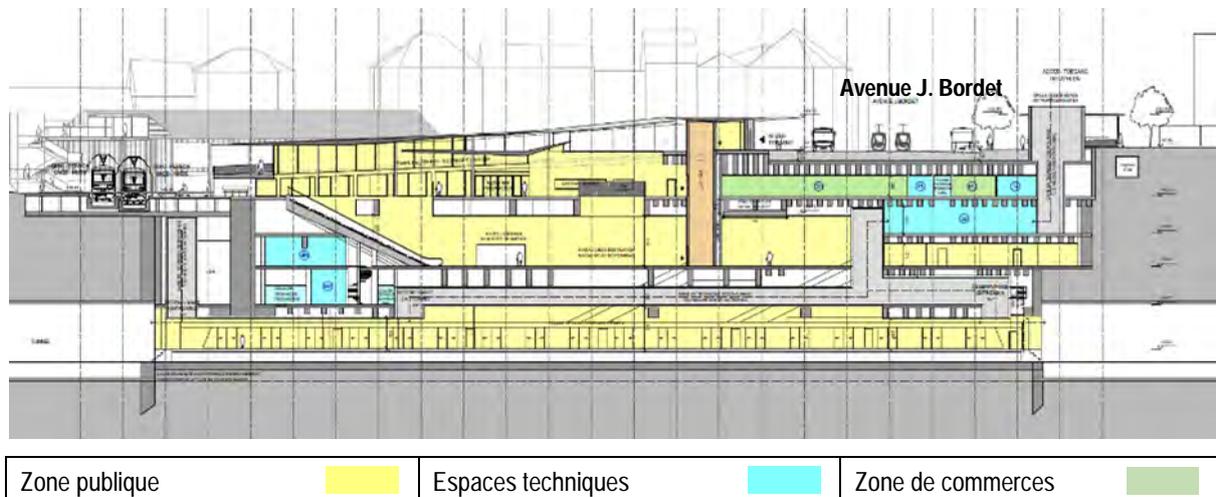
Station Bordet, coupe longitudinale (BMN, 2018)
